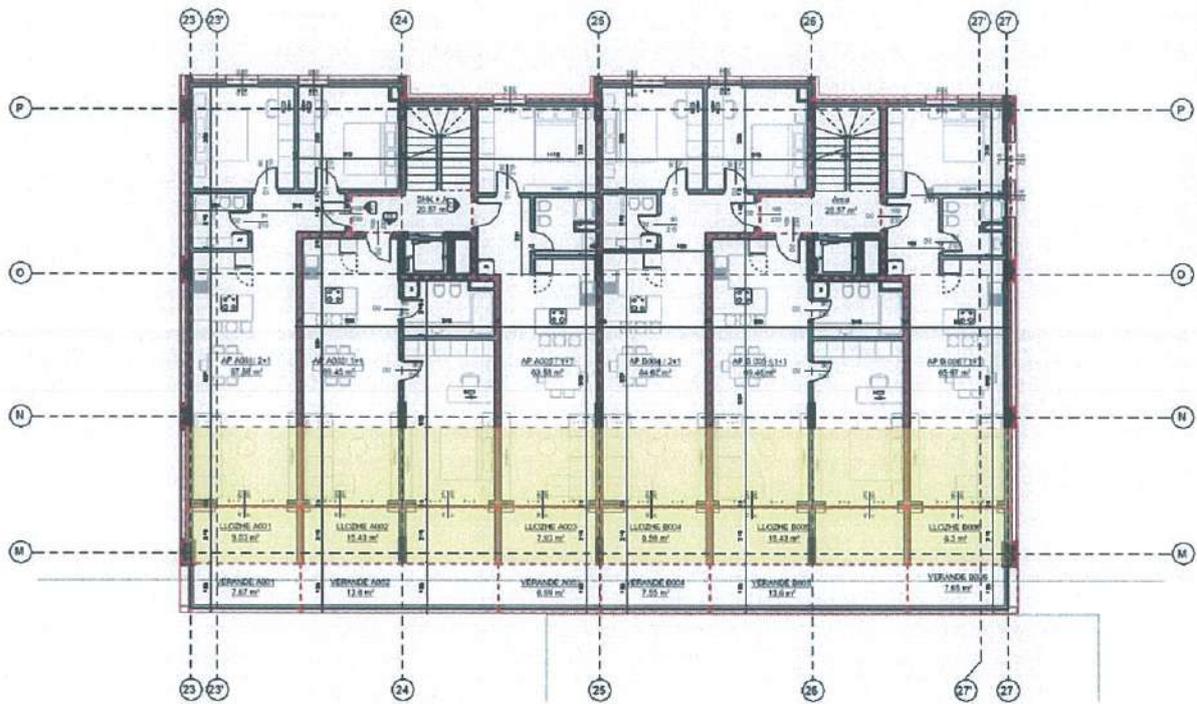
Planimetria në kuotën abs. +81.68, sipërfaqja mbitokë
